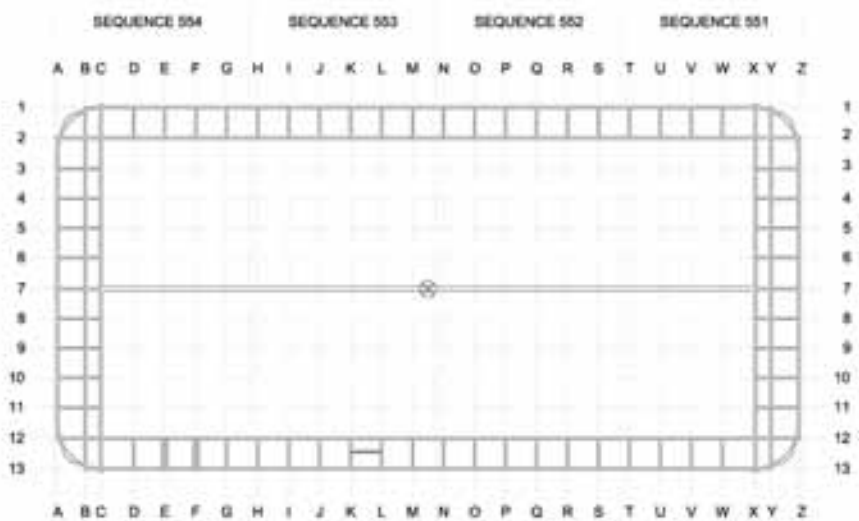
Sección horizontal de la estructura hasta la cota +46.50 desde nivel de dique seco. Doble casco alrededor de los tanques de LNG. Muros exteriores de hormigón armado y postesado de 0,6m de espesor.
